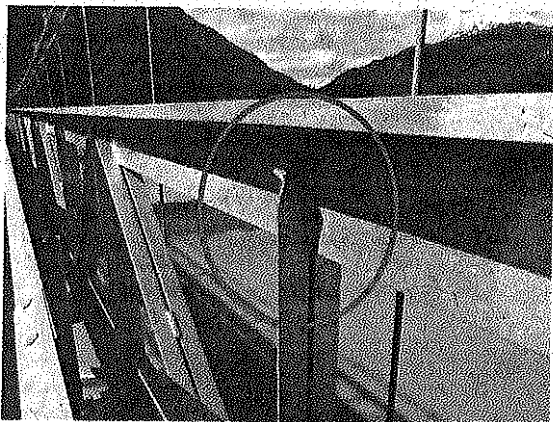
04/12/2017: Rastros de corrosión en elementos metálicos.
